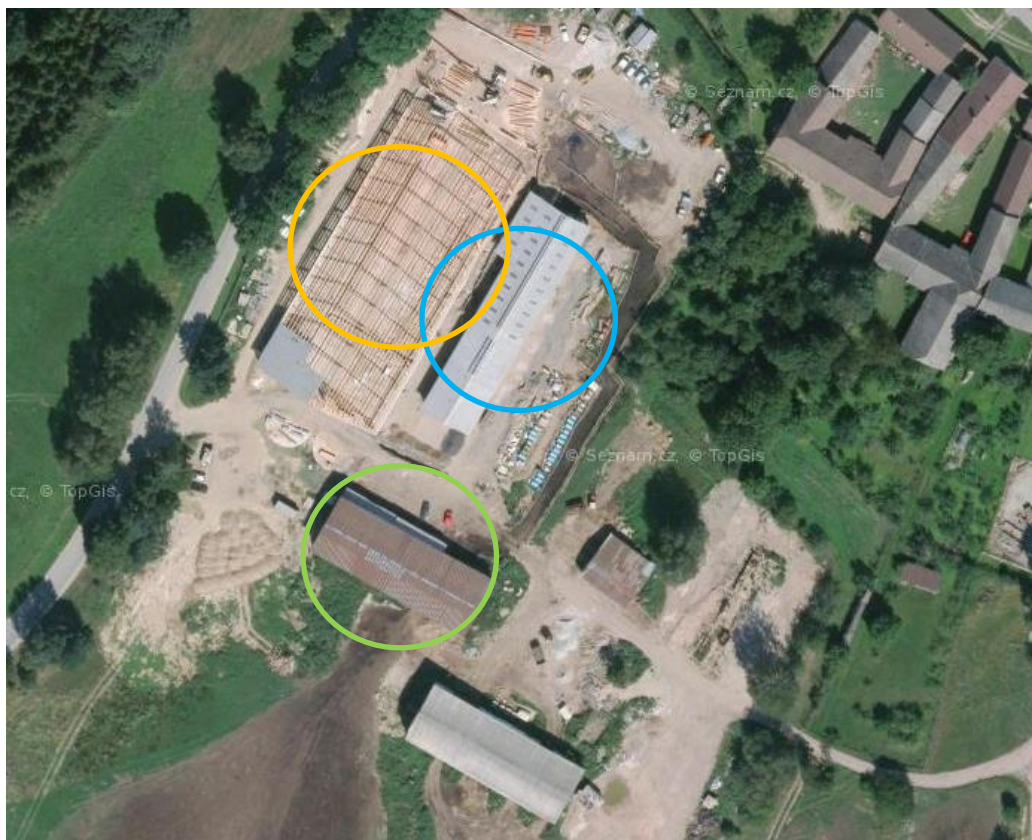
Původní stáje a dojírna farmy Bednárec před změnou
